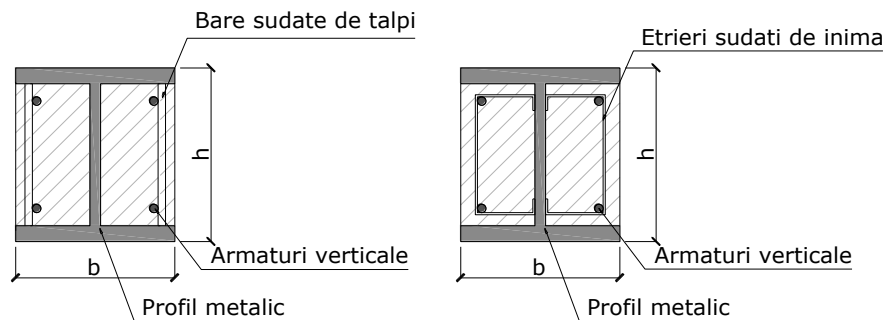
Detalii generale pentru armarea transversală a elementelor compozite parțial înglobate în beton
